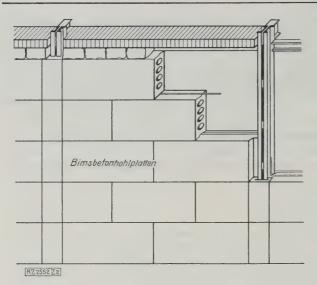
Stahlskelettwand mit Bimsbeton-Hohlplatten.
